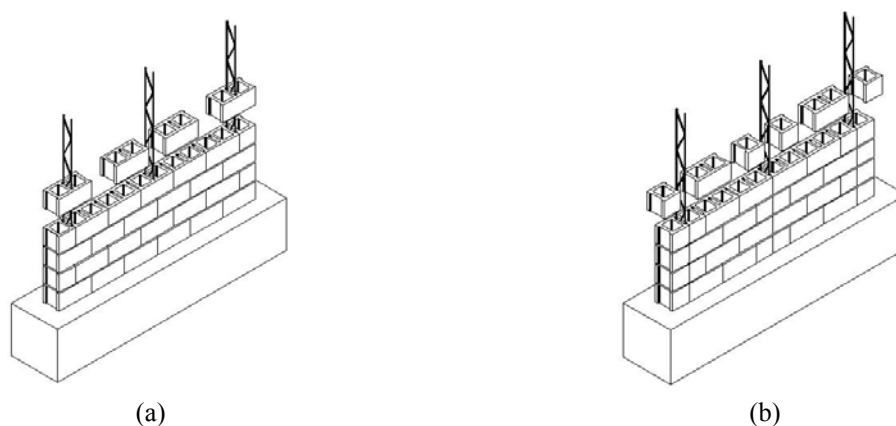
Aparelhos para paredes de alvenaria armada: (a) tradicional; (b) junta contínua armada [17]
